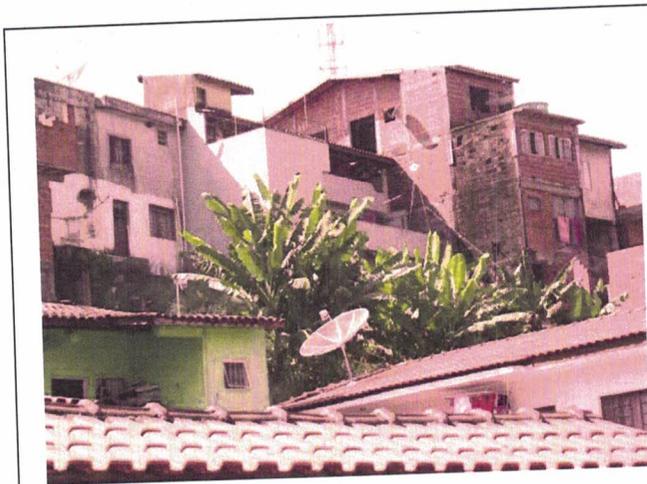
Na área vistoriada, podem ser encontrados taludes de corte e/ou aterro na porção de fundo dos terrenos.
